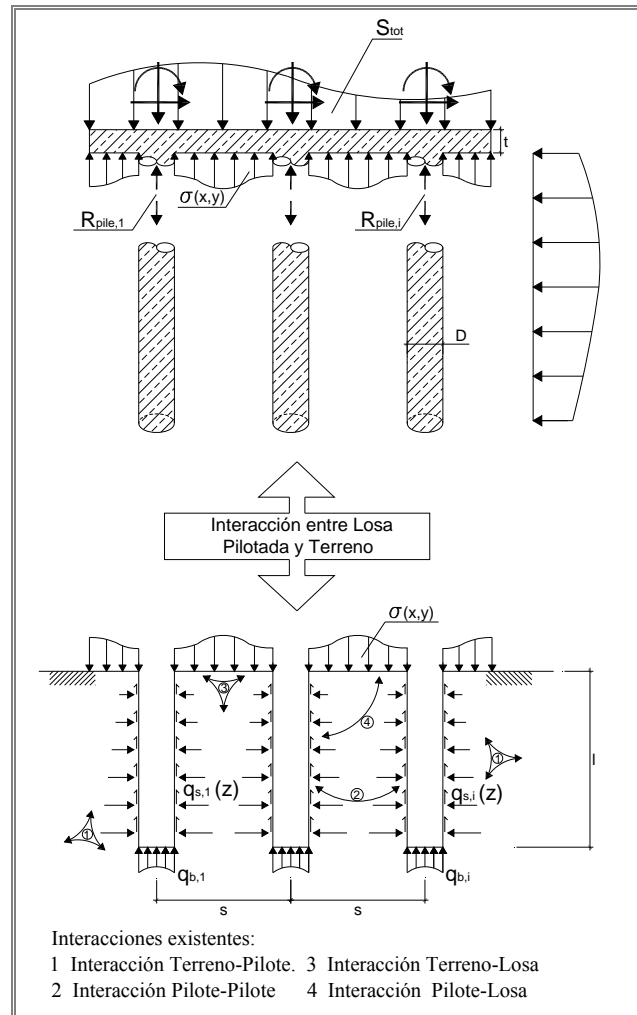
Fases del sistema e interacción entre ellas de una cimentación mixta de losa pilotada. (Poulos, 2000).
